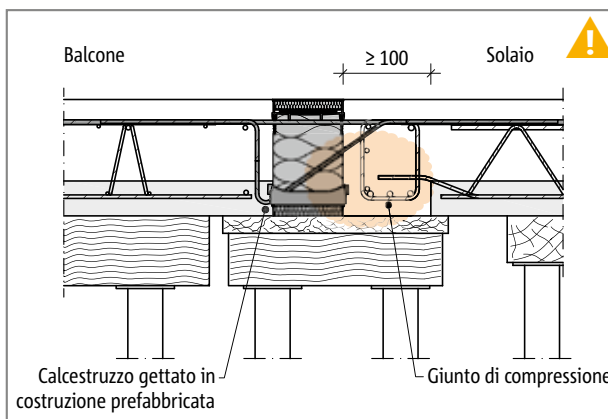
Schöck Isokorb® XT tipo KL: appoggio indiretto, montaggio con piastre prefabbricate (qui: $h \leq 180$ mm), giunto di compressione lato solaio
